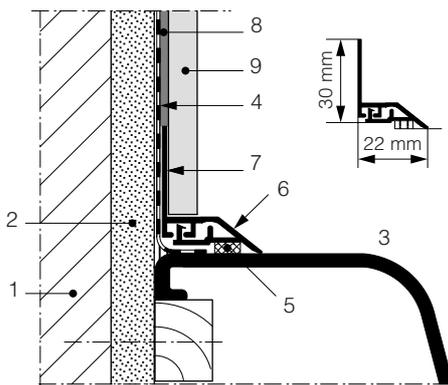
Joint souple préformé au raccord d'une baignoire et d'un carrelage.
